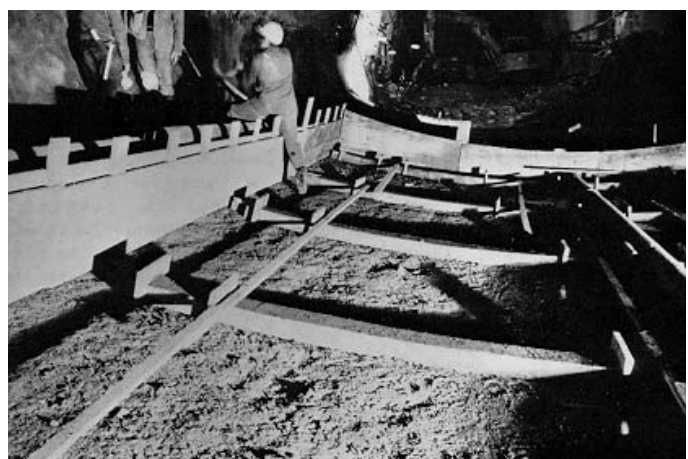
Tunnel T8: Einbau der Stützrippen aus Leichtbeton (Kovari und Amstad, 1979)
